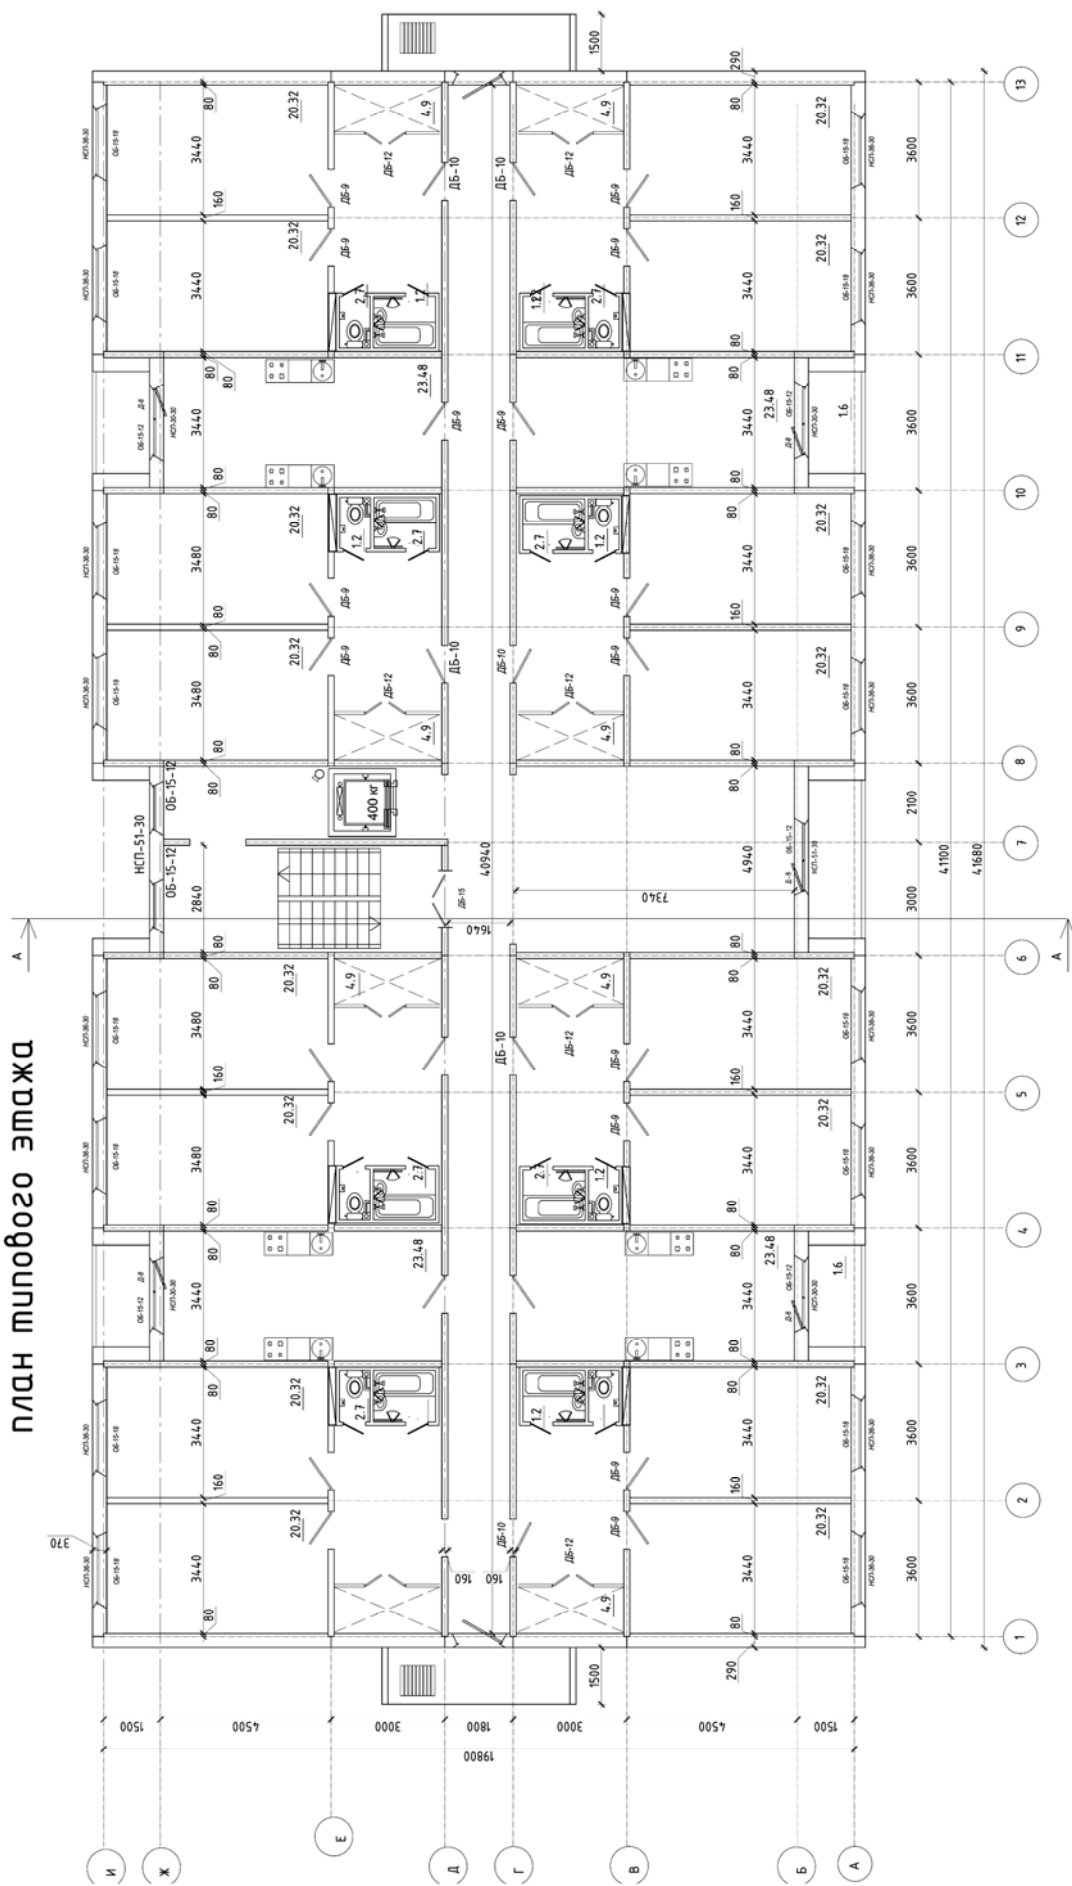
Образец выполнения плана типового этажа жилого здания. Схема расположения секций
